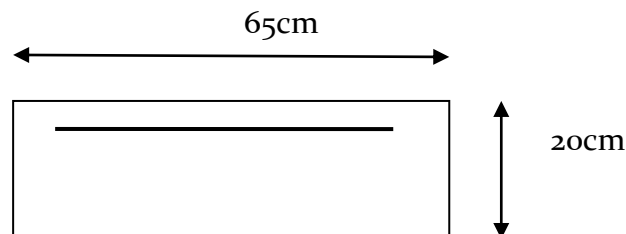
coupe schématique de la poutrelle (travée)
